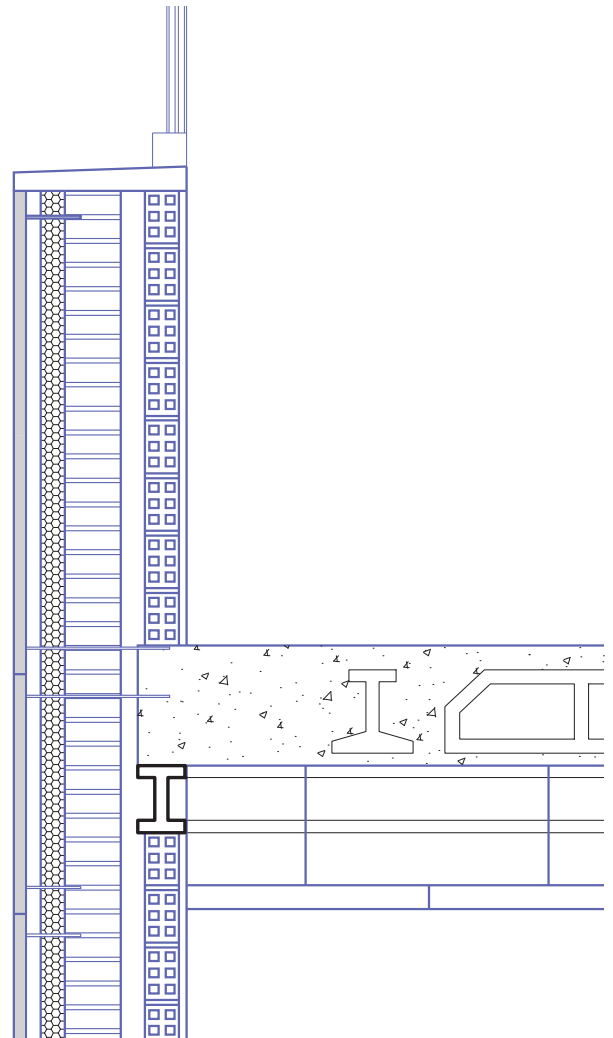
Detalle de la fachada rehabilitada tras la aplicación de la nueva fachada ventilada. Figura elaborada por autor.
